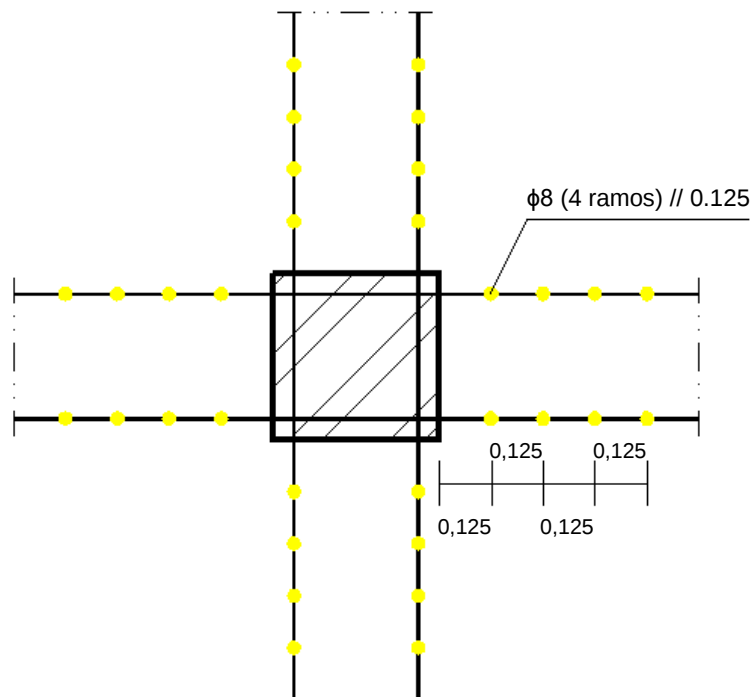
Armaduras de punçoamento em planta no modelo E4A
